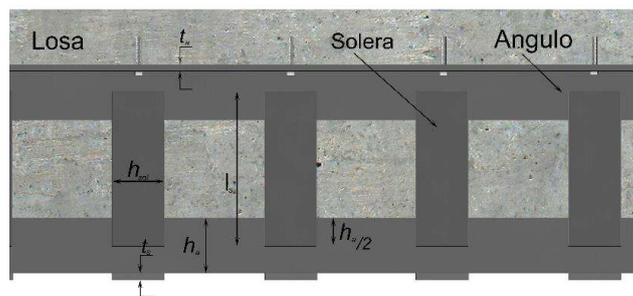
b - Sección longitudinal de viga encamisada con ángulos y soleras
